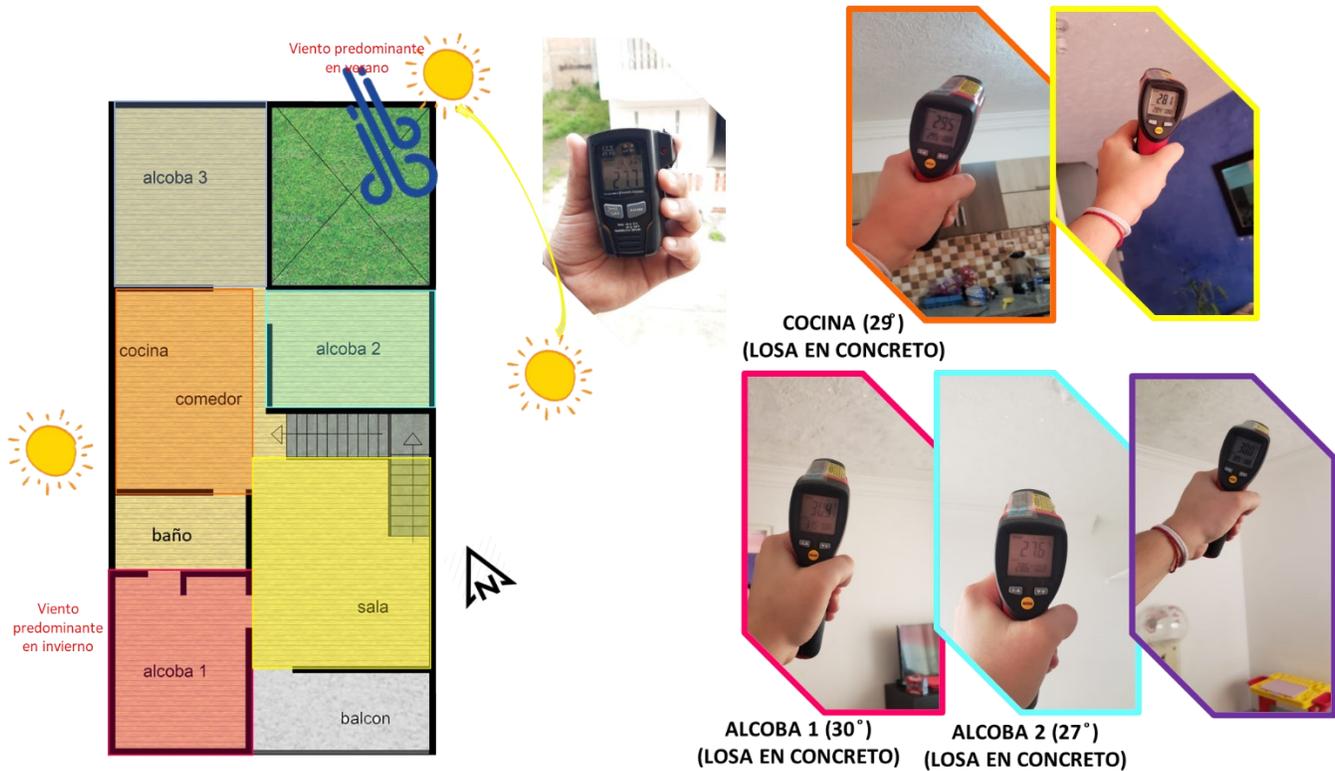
planimetría y fotos Fuente: propia Realizado: abril
